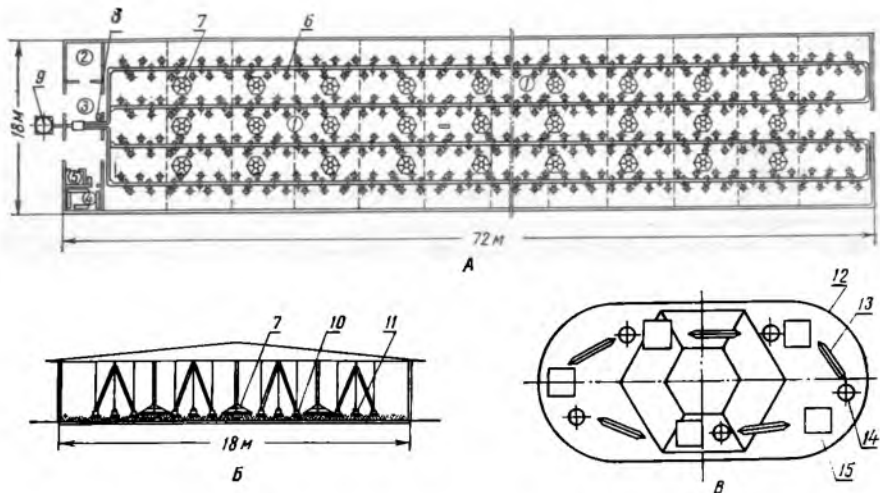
План (А) и поперечный разрез (Б) птичника для напольного выращивания цыплят от 1 до 140—150 дней и план (В) расположения оборудования в ограждении брудера (проект Гипросельхозптицепрома):
